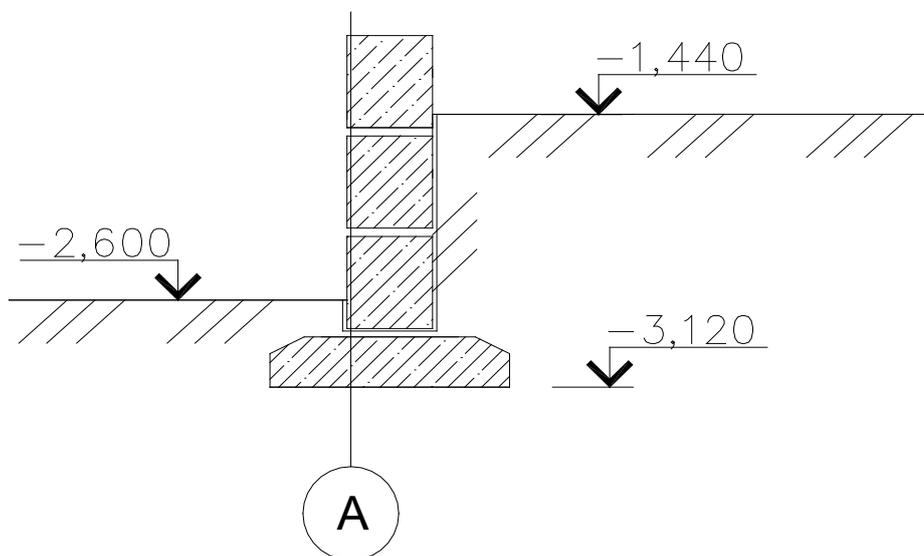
Схема к определению глубины заложения фундамента наружной стены
